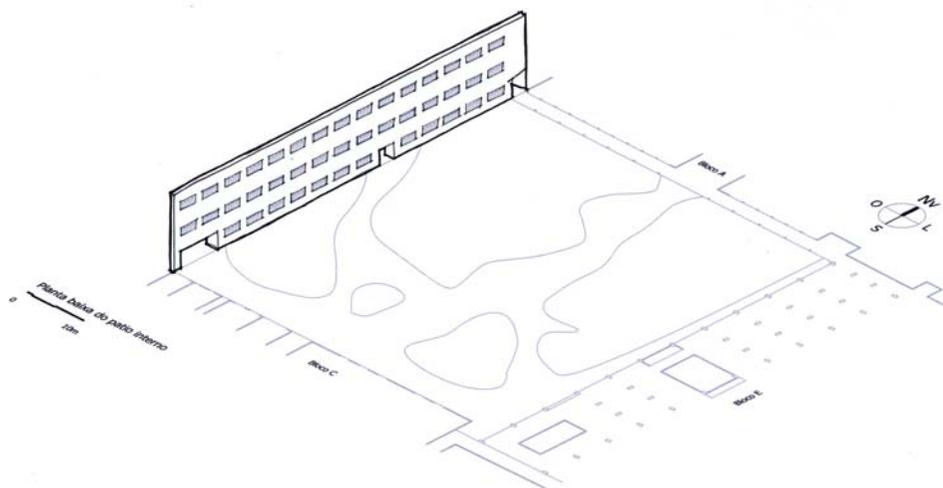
Estudo dos planos verticais, fachada Oeste do pátio interno do CEFET.
